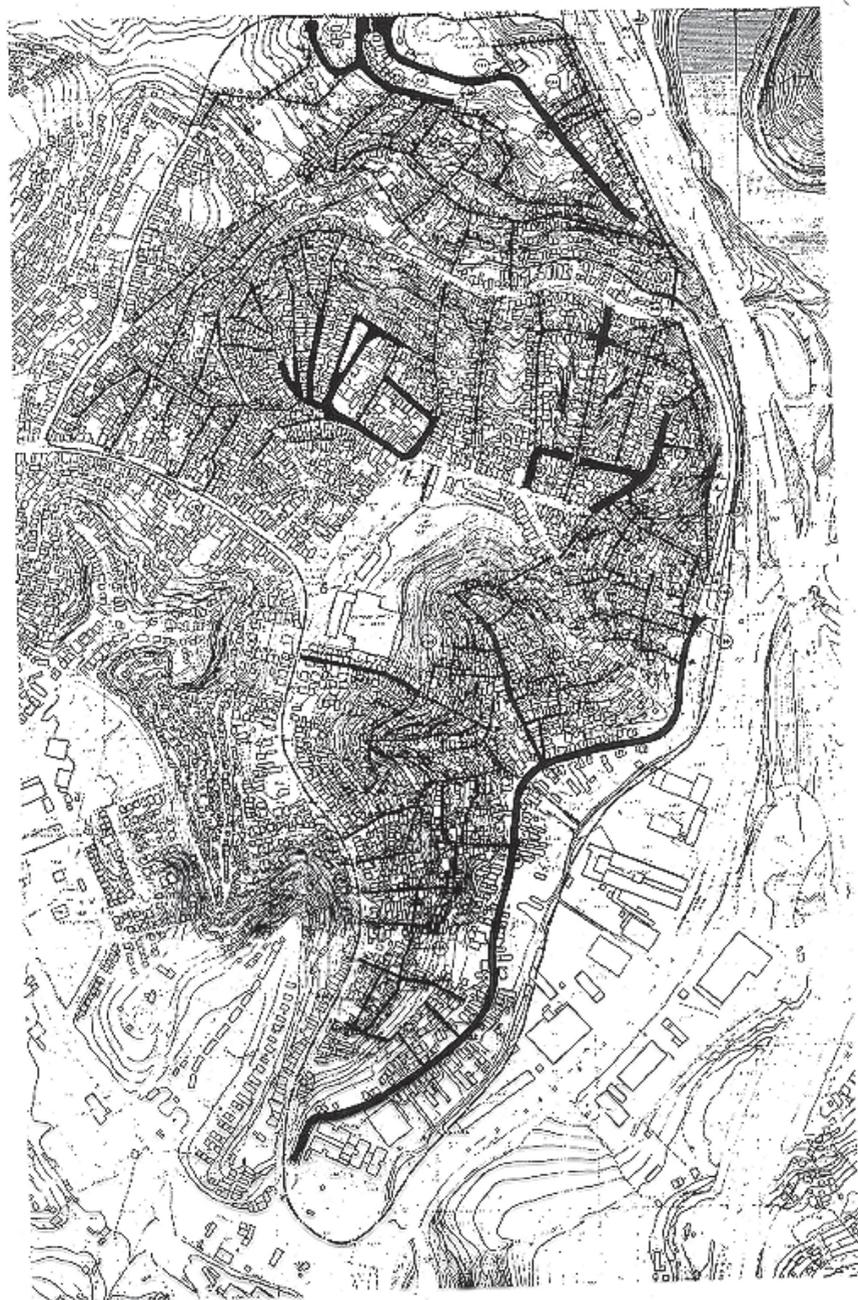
Vias de pedestres em rampas e escadarias drenantes - Exemplo de projeto em planta
